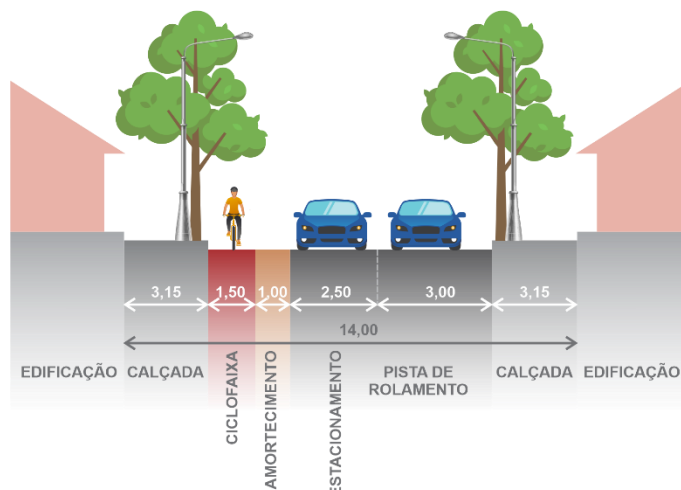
Via Coletora Tipo 1: estrutura e dimensões
